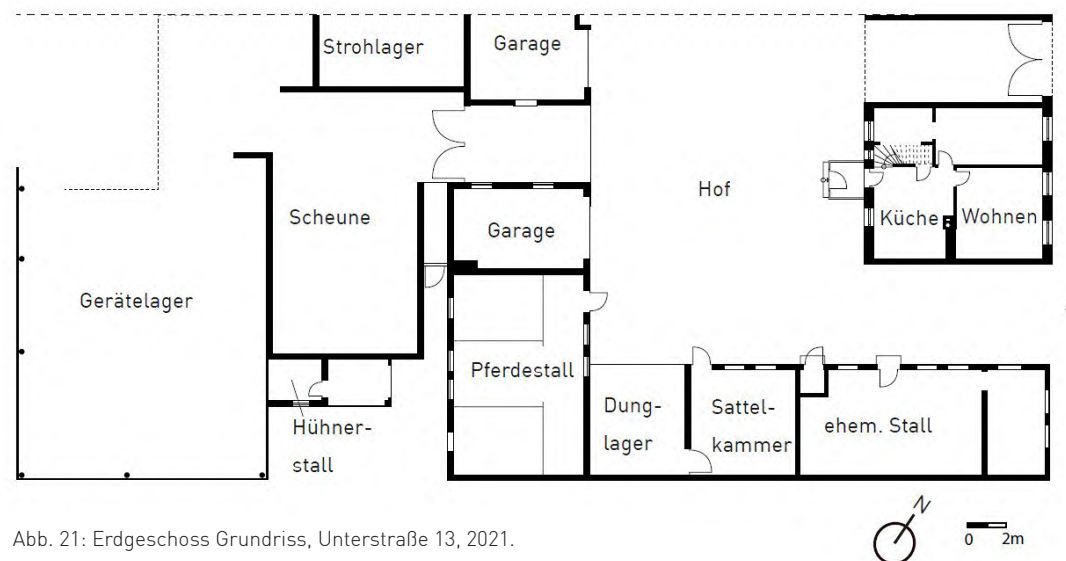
Erdgeschoss Grundriss, Unterstraße 13, 2021.
